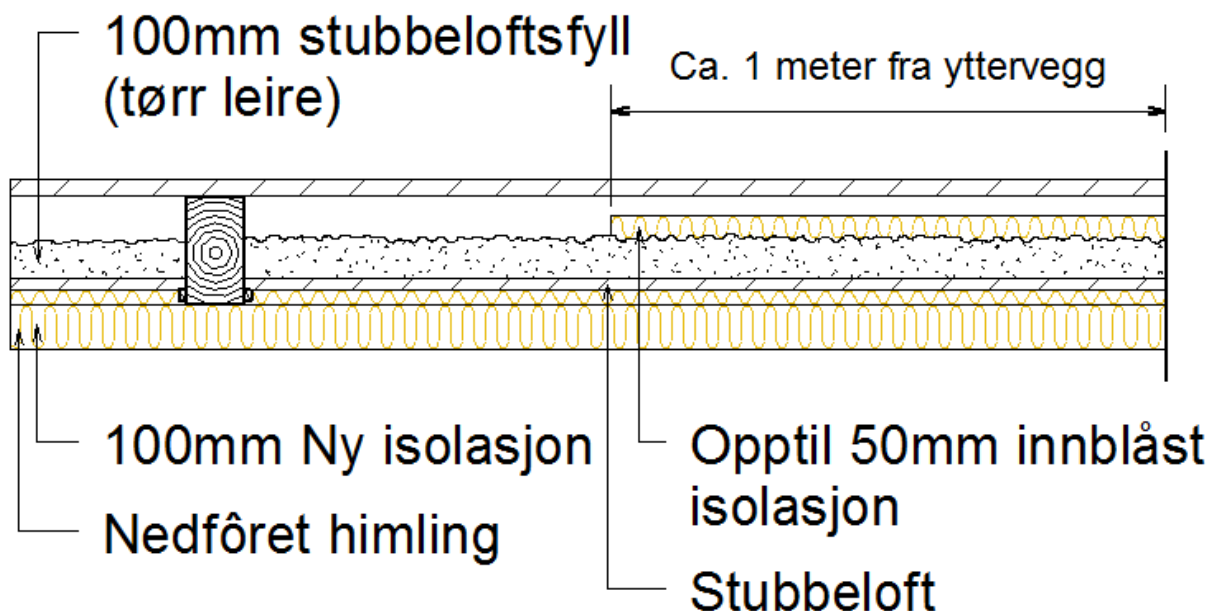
Etterisolering ved å erstatte eksisterende stubbeloftsfyll
